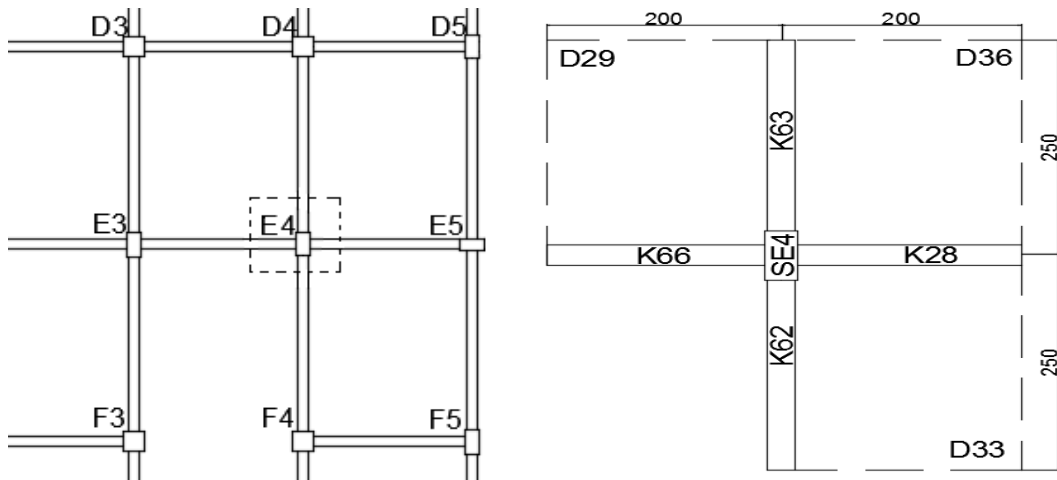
Plan 2 B2 kolonunun Plan 2'deki yük dağılımı ve kalıp planındaki yeri.
